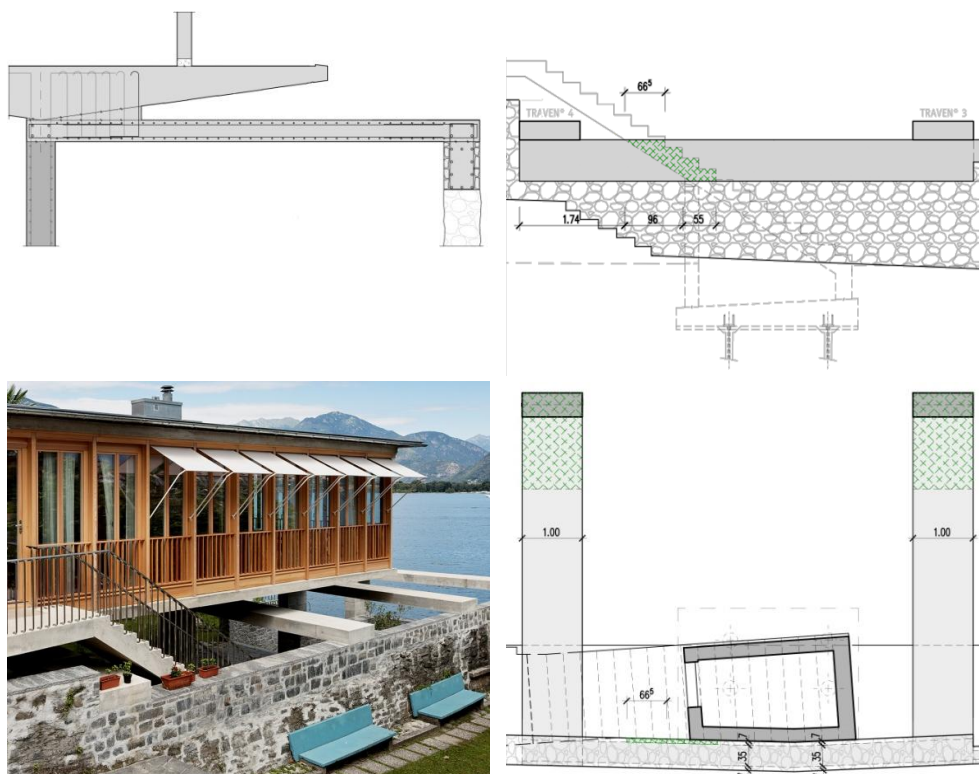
In alto*: sezione trasversale della struttura. *In basso*: pianta strutturale dell'abitazione.
